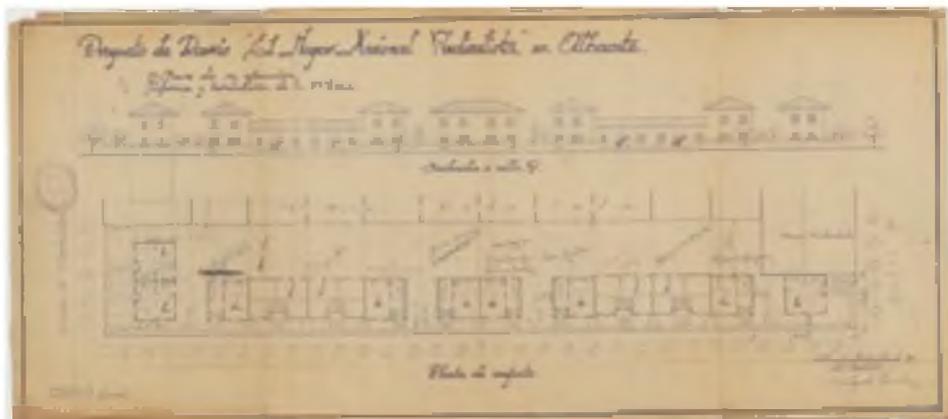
Grupo Barrio El Hogar Nacional Sindicalista. 1ª Fase: Plantas y alzados zona 2. Caja nº 39.
